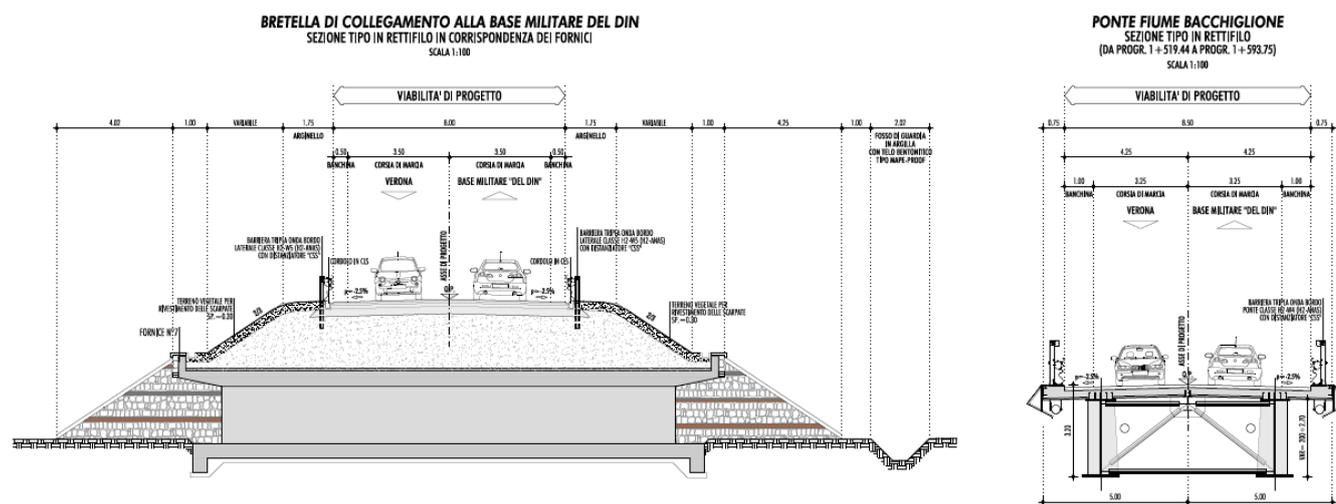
BRETELLA DI COLLEGAMENTO BASE MILITARE DEL DIN - COMPOSIZIONE DELLA SEZIONE STRADALE
